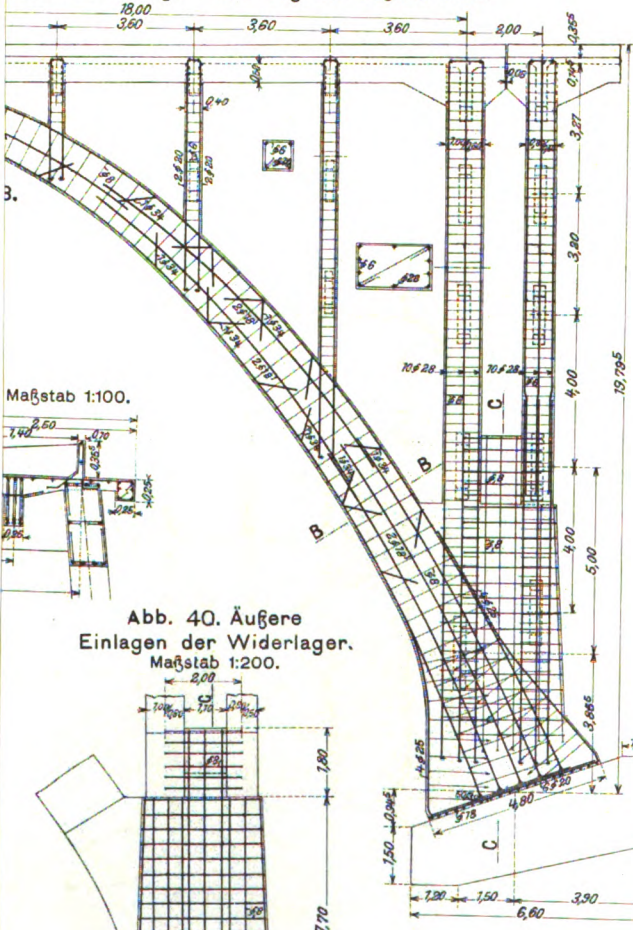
Äußere Einlagen der Widerlager. Maßstab 1:200.
